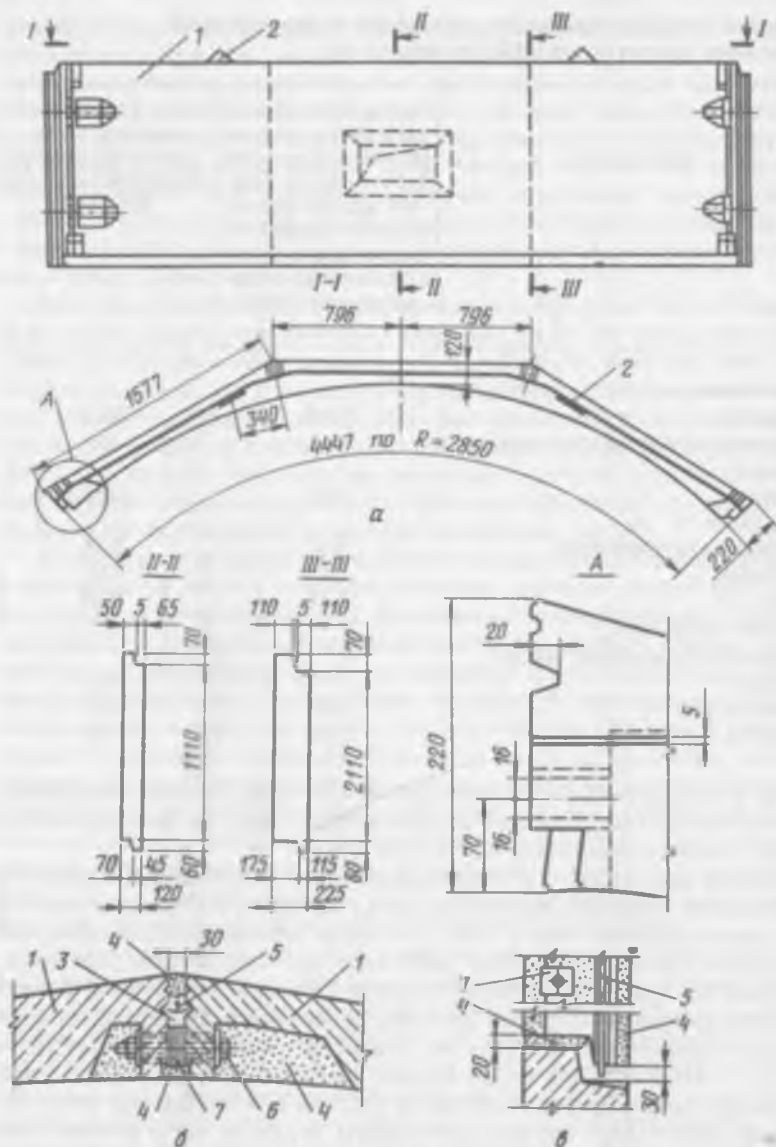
Железобетонный предварительно напряженный элемент стен силосов диаметром 6 м полигонального очертания:
